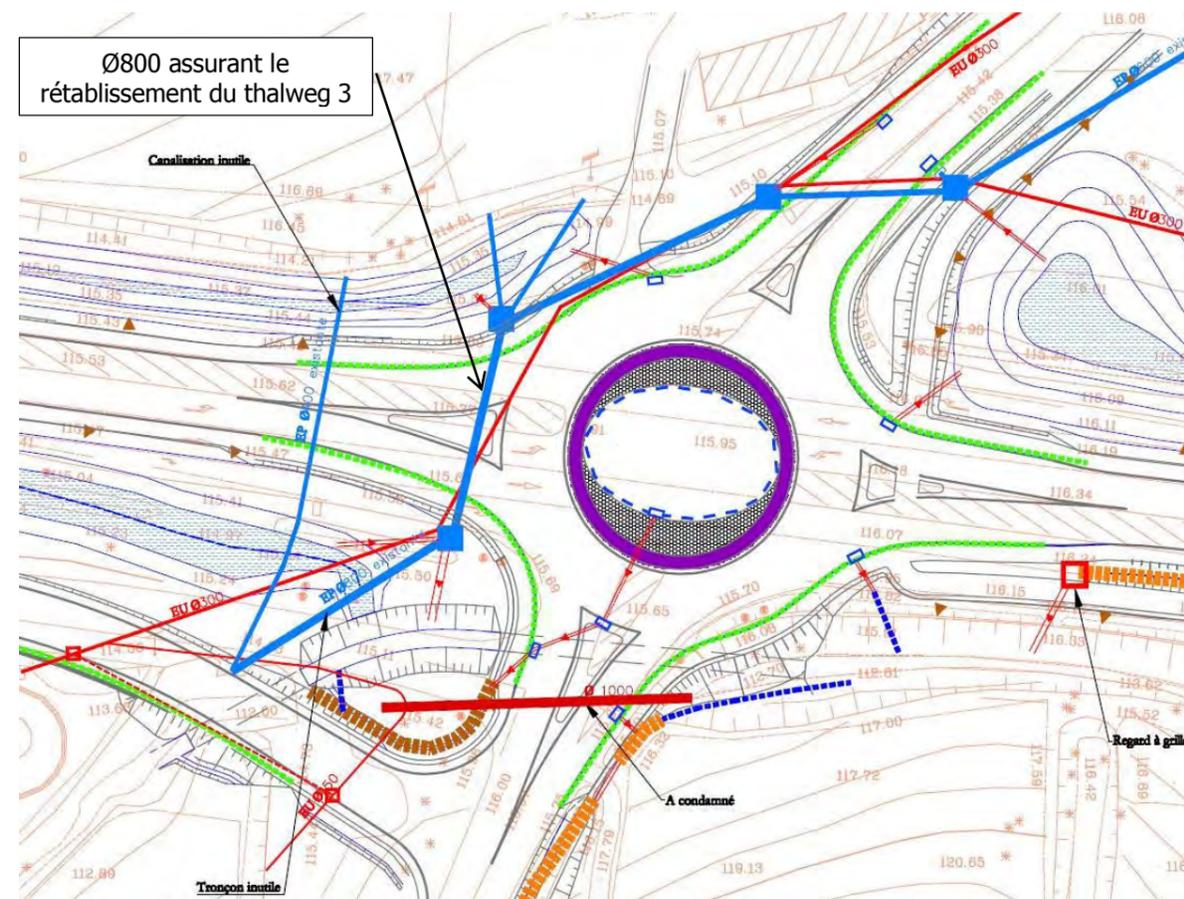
Extrait du plan DCE du giratoire RN164/RD1 au droit du thalweg 3
